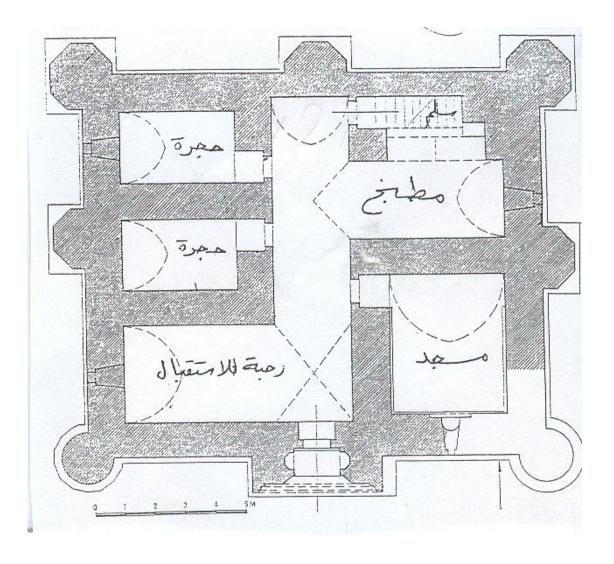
مقطع ومسقط افقي لكشك "حيدربيك"
